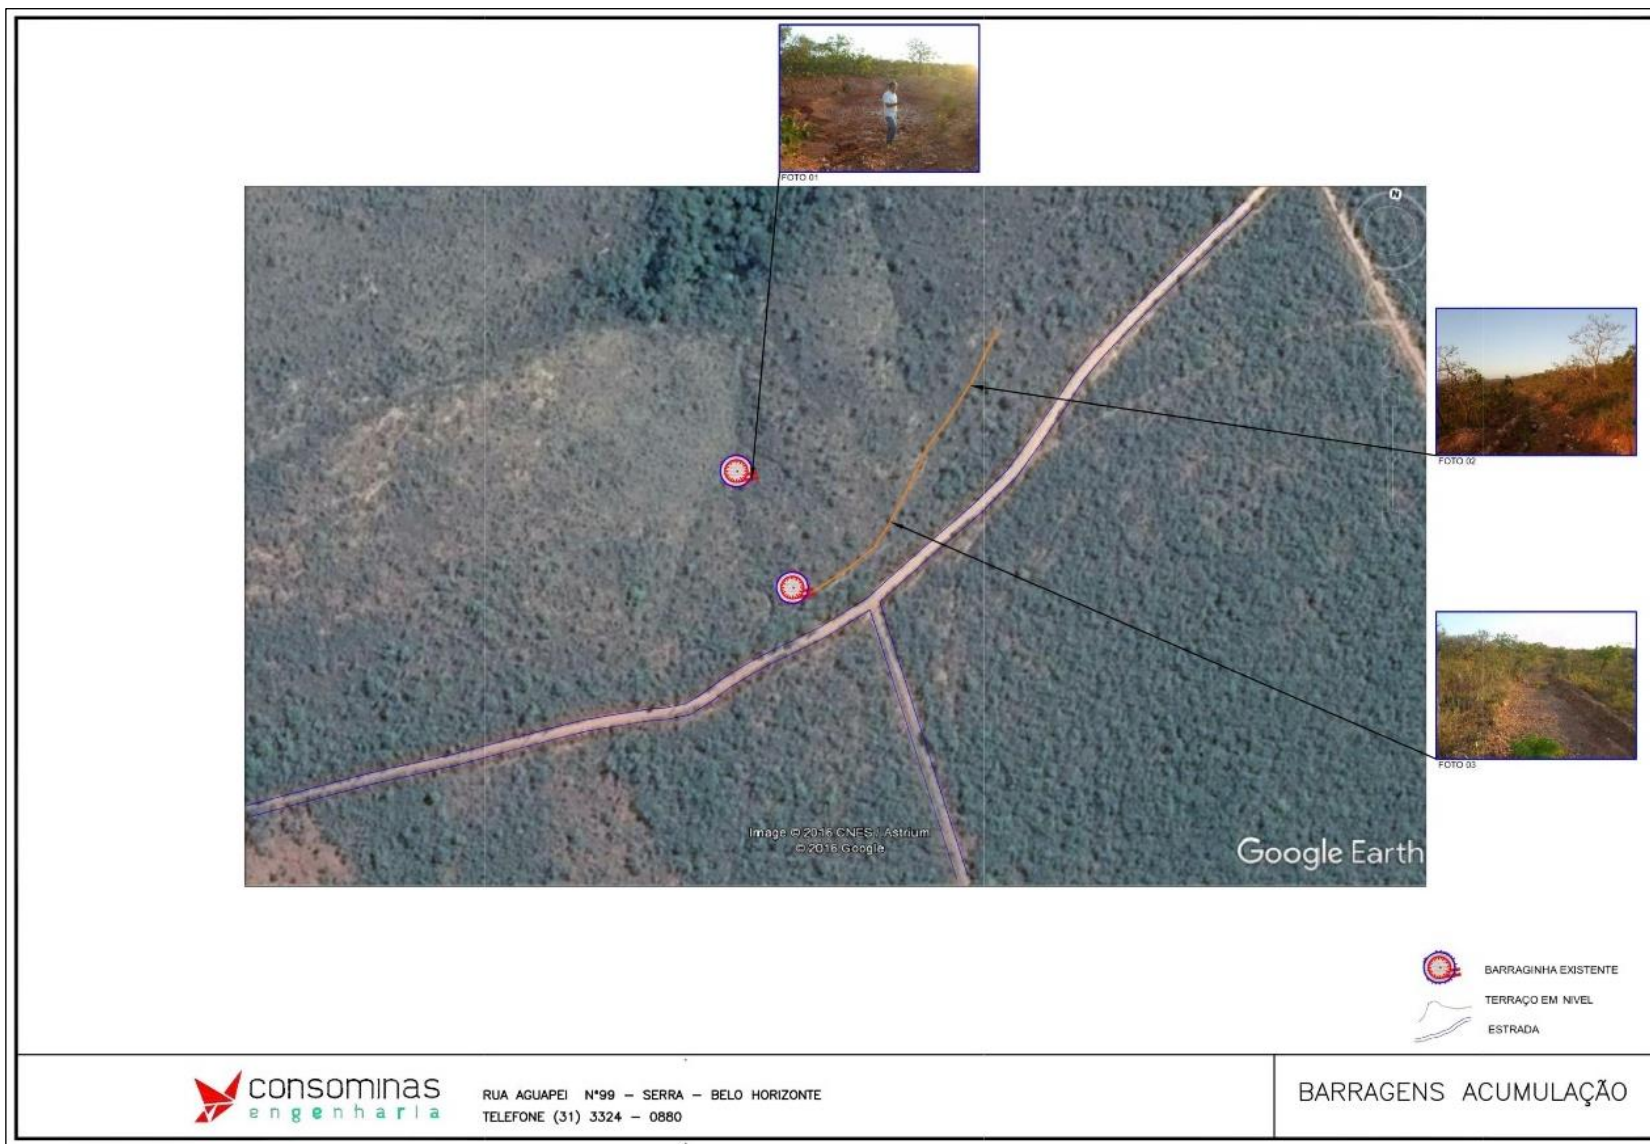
Croqui 03 – Complexo de ações – Área 4
